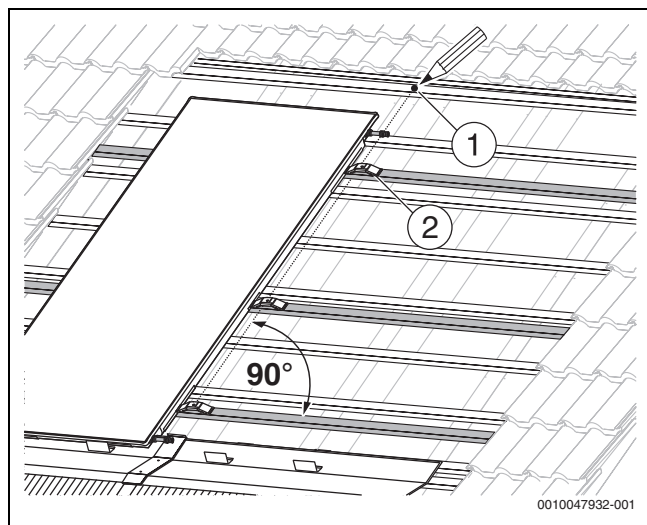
Posizione di montaggio dell'elemento di collegamento superiore
